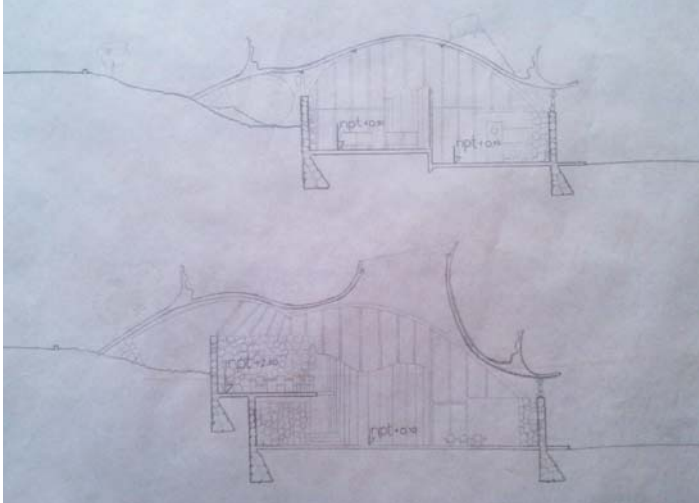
Cortes donde se puede observar la forma en que la estructura se apoya en el terreno.
